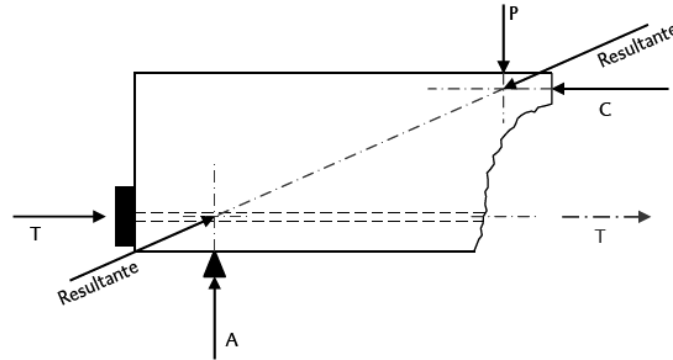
a. Esquema de sólido rígido de una viga con armadura sin adherencia (P. Padilla)
